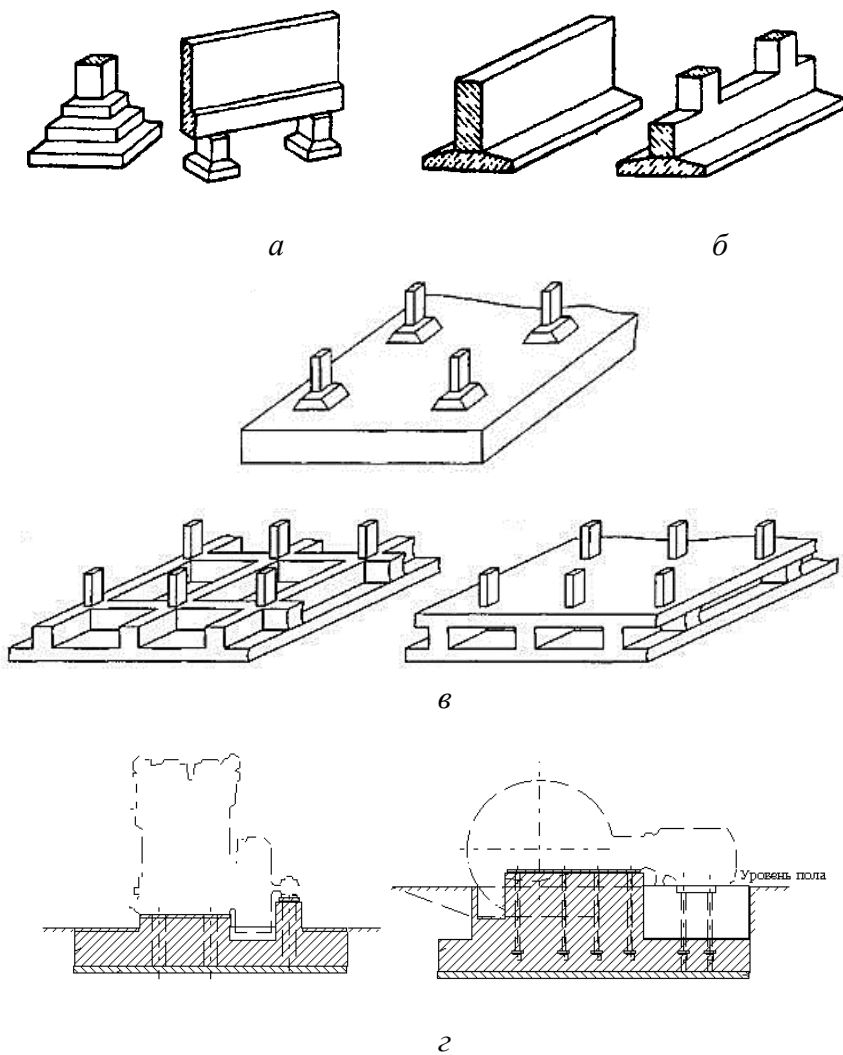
Виды фундаментов мелкого заложения для многоэтажных зданий:
